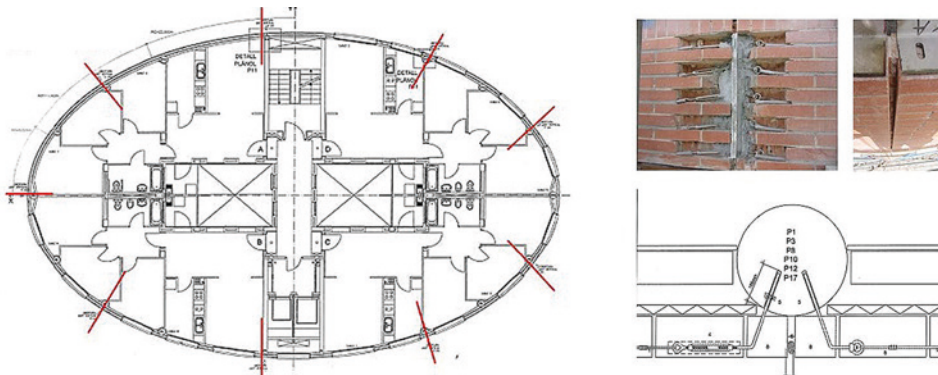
Provisión de juntas de dilatación en la fachada de un edificio de forma ovoide. Las juntas se disponen coincidiendo con la ubicación de los pilares. Los tramos entre juntas de la fachada son soportados por cables tensados anclados en los pilares.
